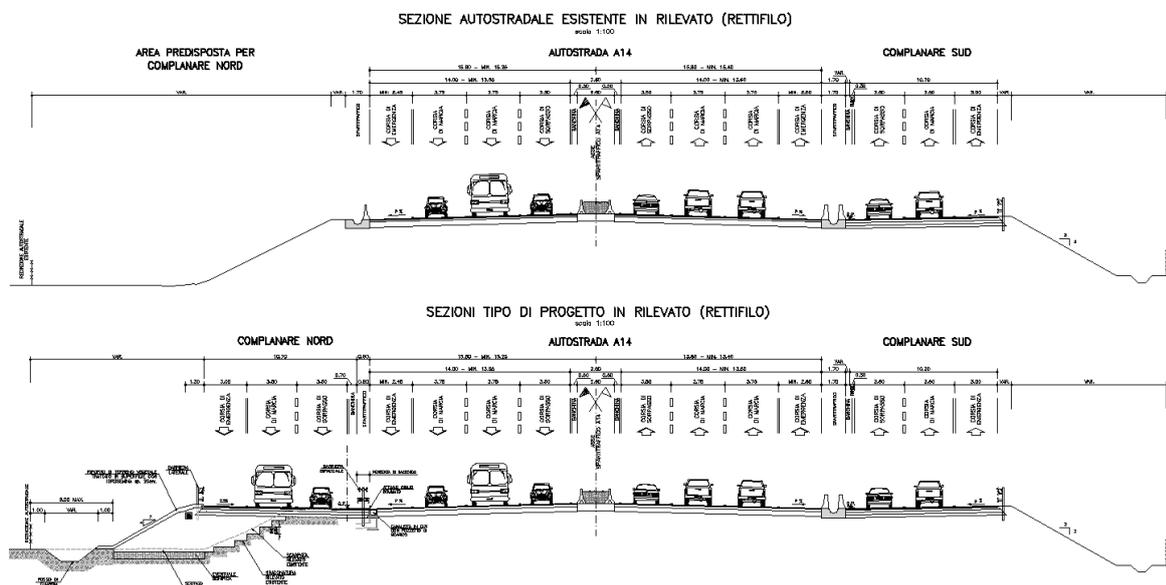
(a) – Sezione tipo allargamento in rilevato
